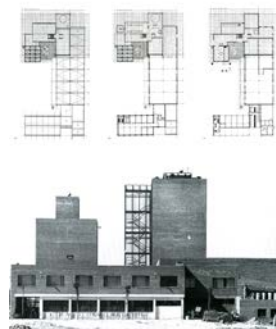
Plantas del conjunto a niveles 0.00, +3.60 y 7.20. Fuente: Arquitectura. Fotografía del edificio desde el sur. Fuente: Informes de la Construcción. Los añadidos en la vivienda del guarda no figuran en planos.
